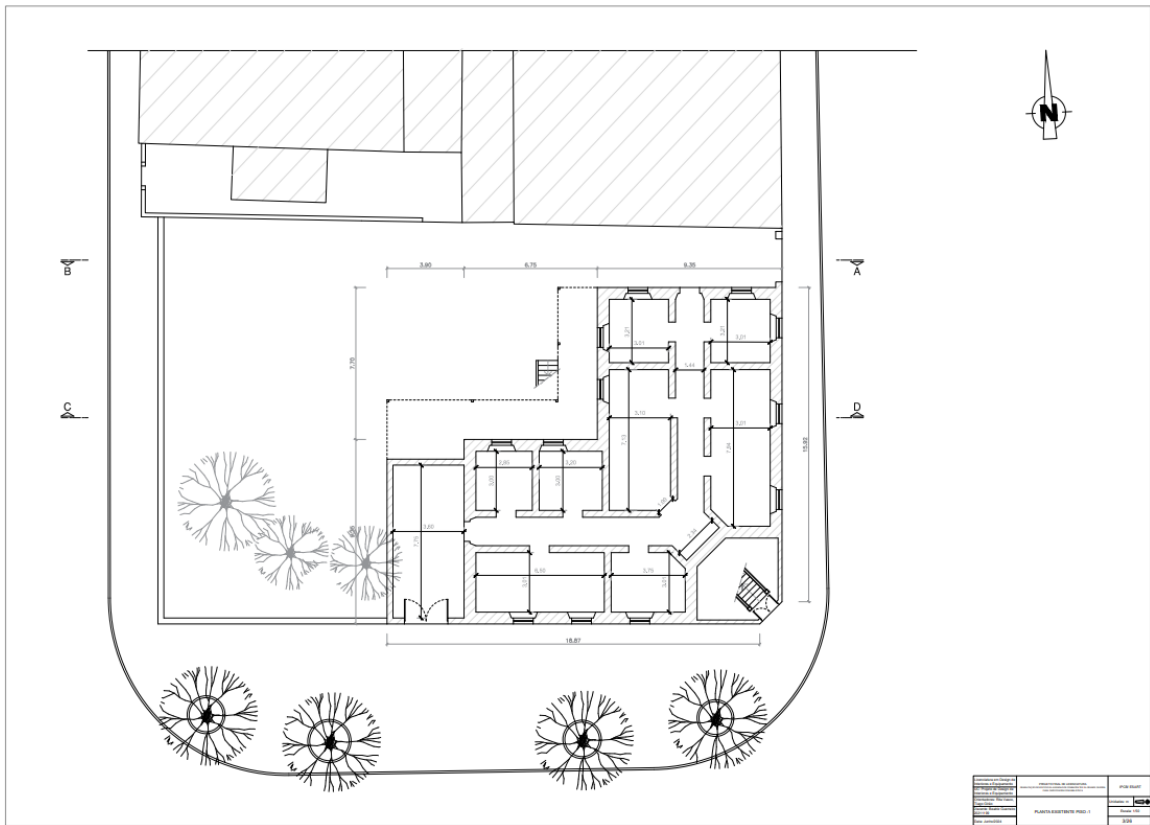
Planta existente piso -1, sem escala. Fonte: Autor
